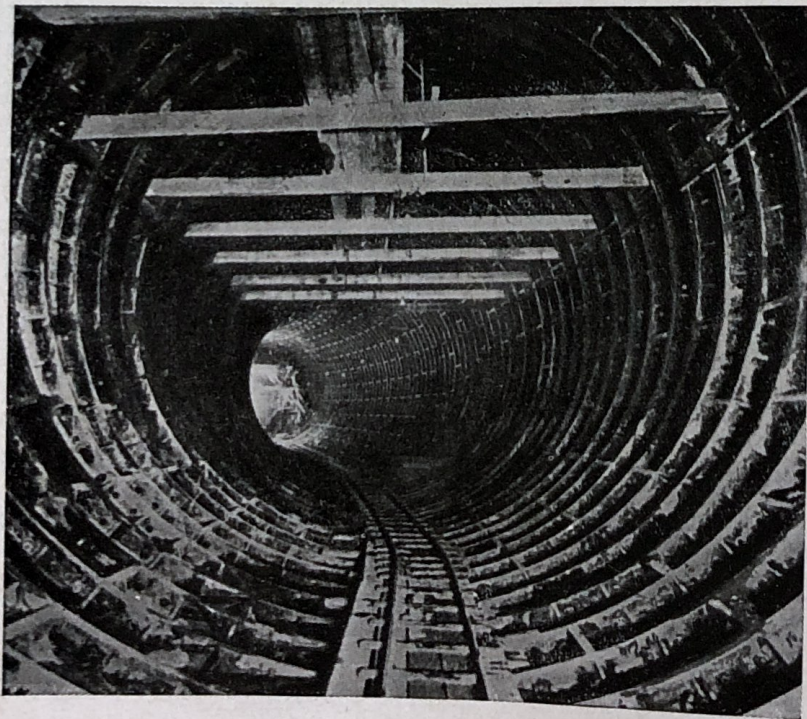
GALLERIA TUBOLARE DELL'« UNDERGROUND » DI LONDRA (IN COSTRUZIONE).
